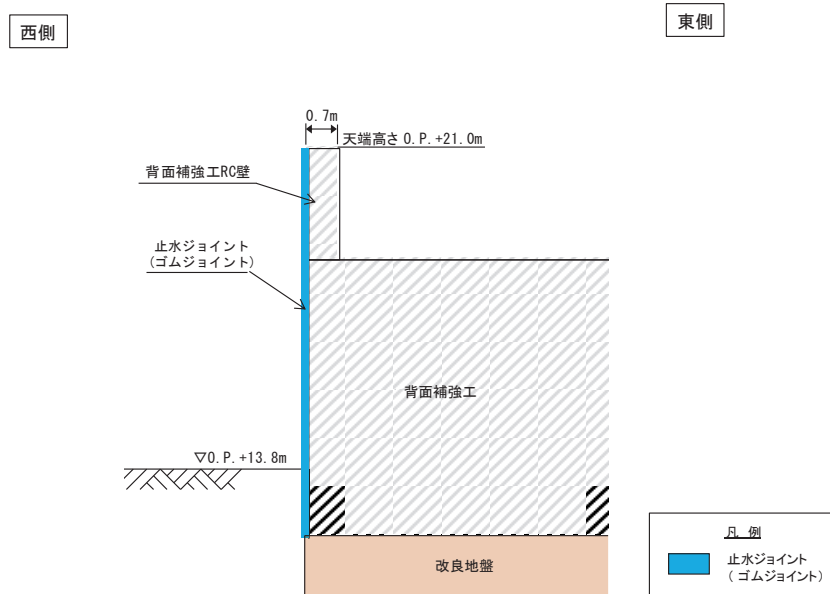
(3) 止水パターン⑫の構造概要(⑫-⑫断面図)
